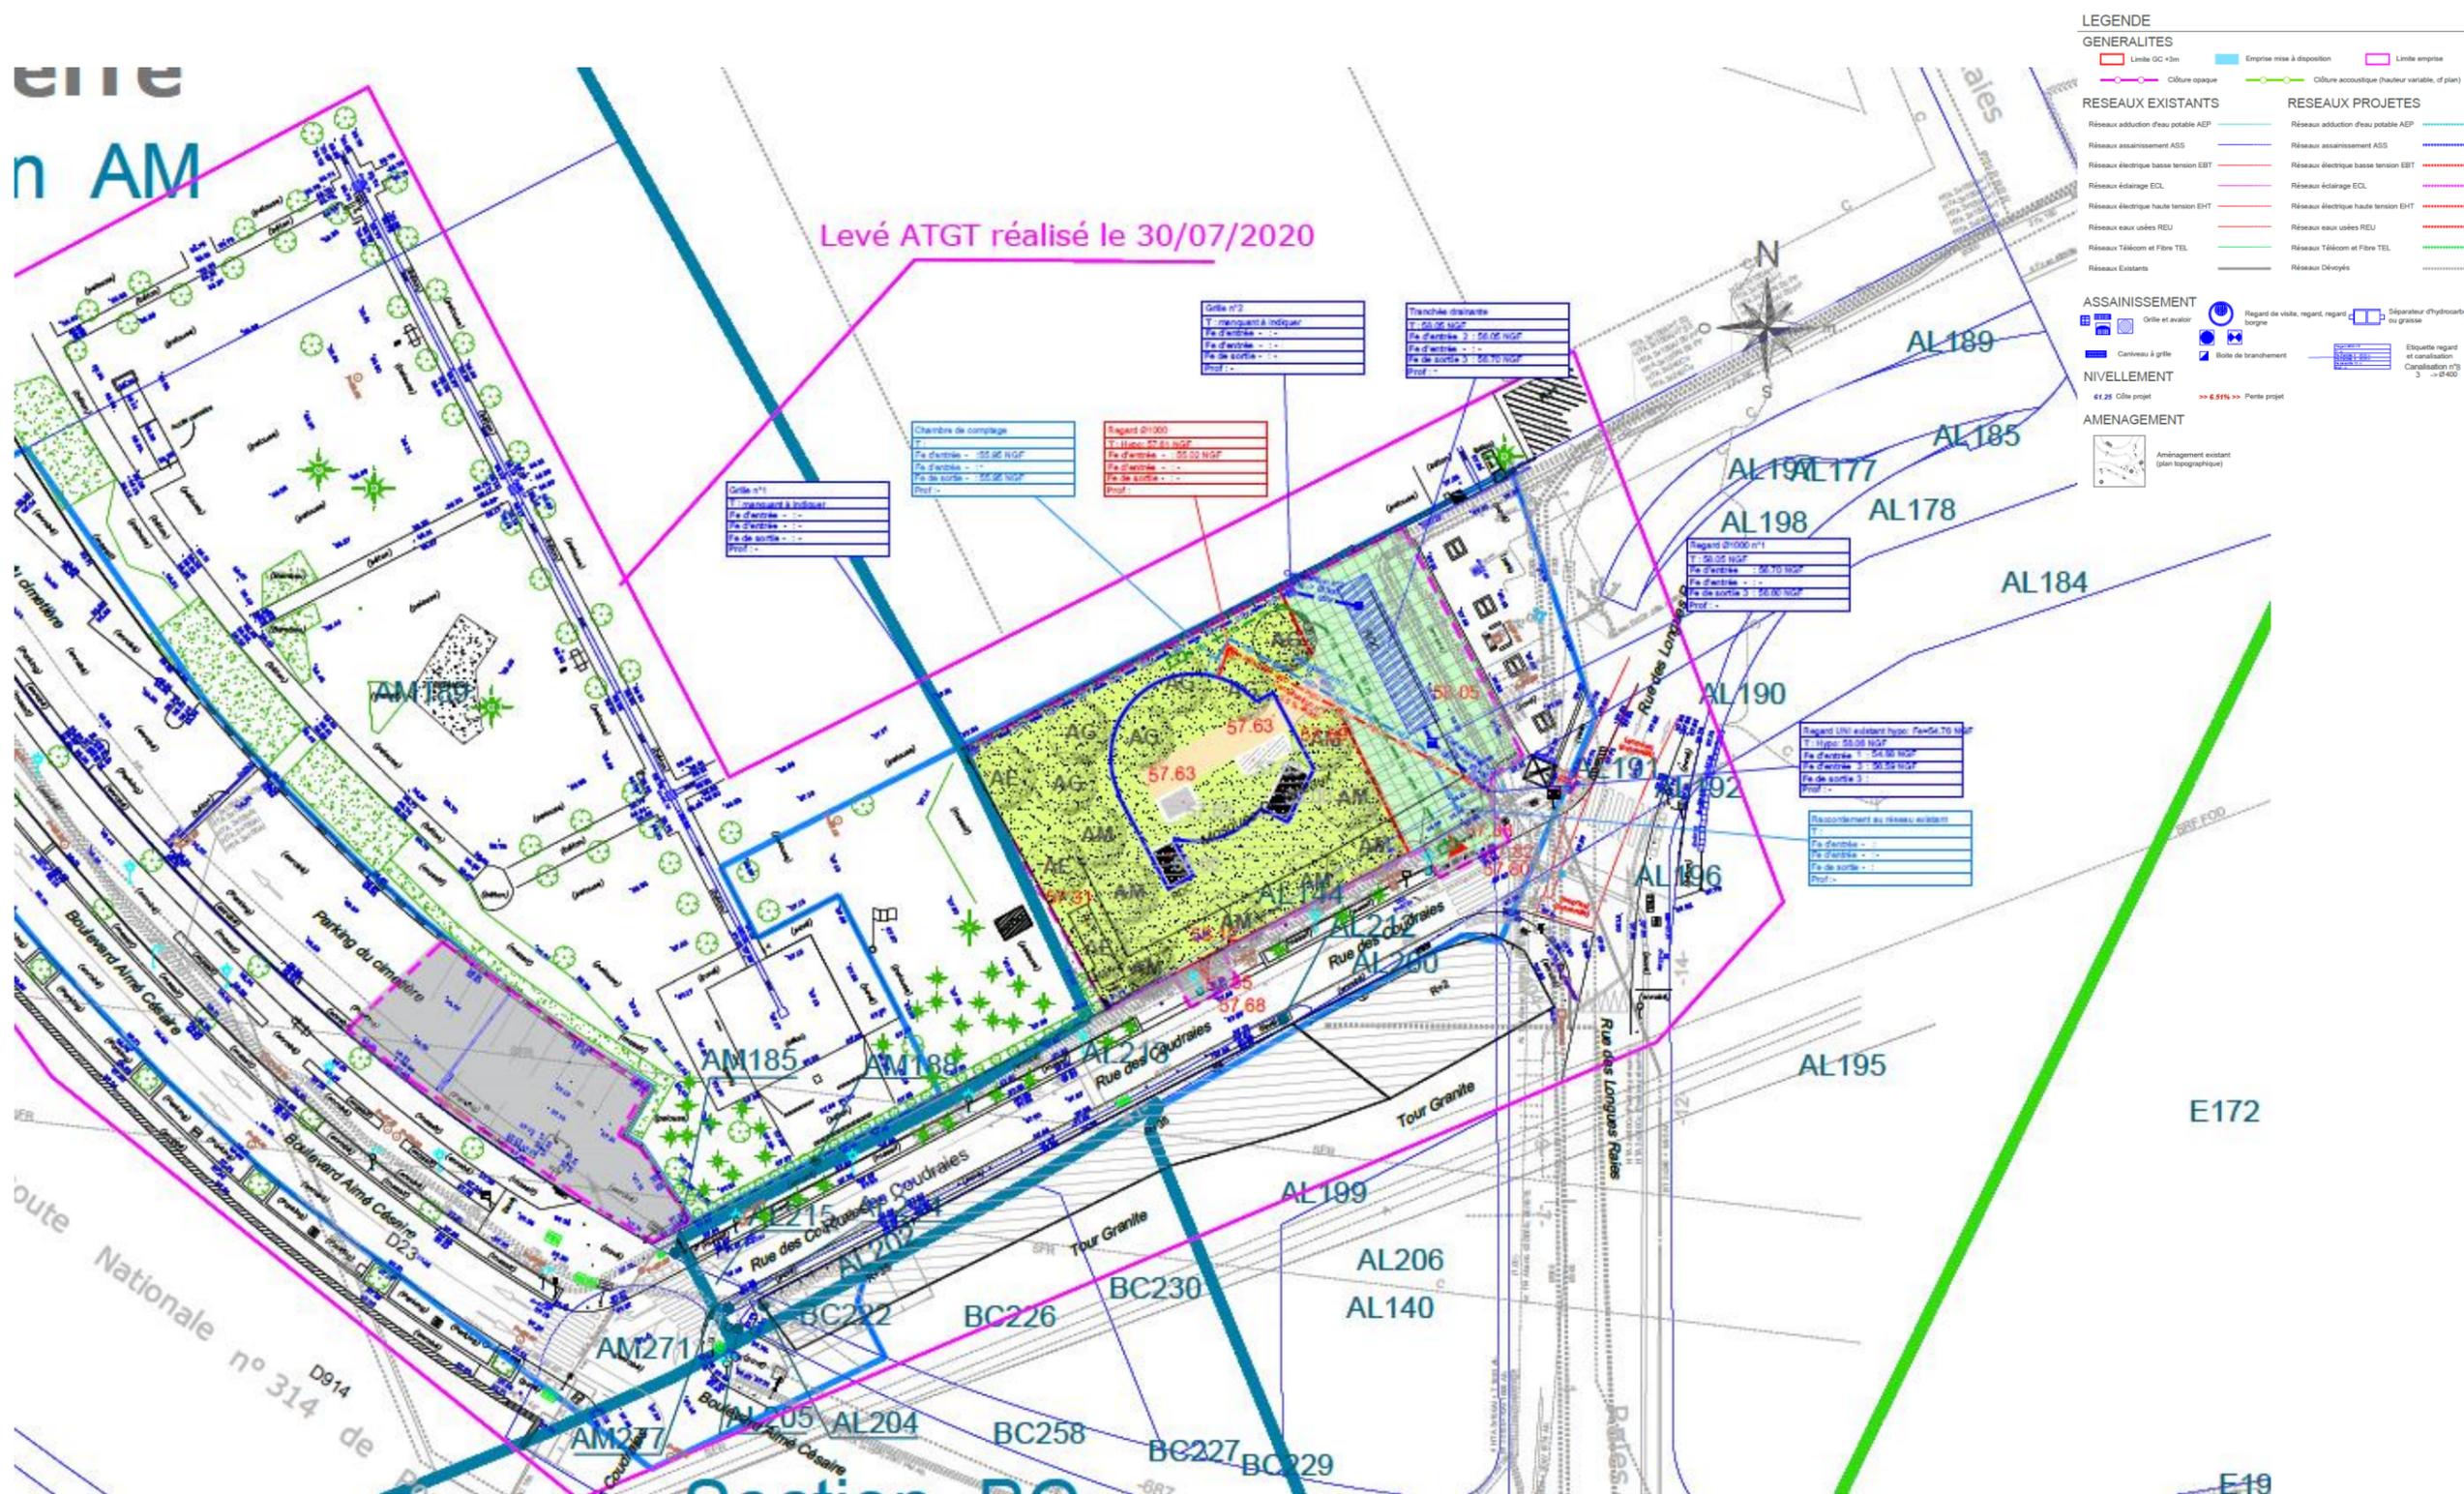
Plan d'assainissement définitif de l'OA 2702P (Source : Groupement Intencités 15, 2023)
